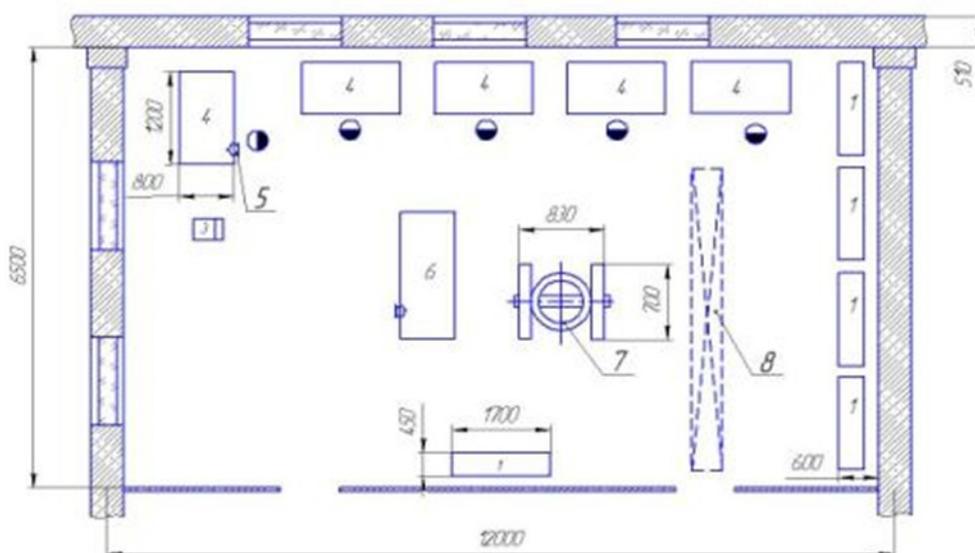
Расстановка оборудования на участке предприятия: 1 - ящик с песком; 2 - контейнер для отходов; 3 - стеллаж для деталей; 4 - инструментальный шкаф; 5 - стол для сортировки деталей; 6 - площадка для агрегатов; 7 - слесарный верстак; 8 - слесарные тиски.
